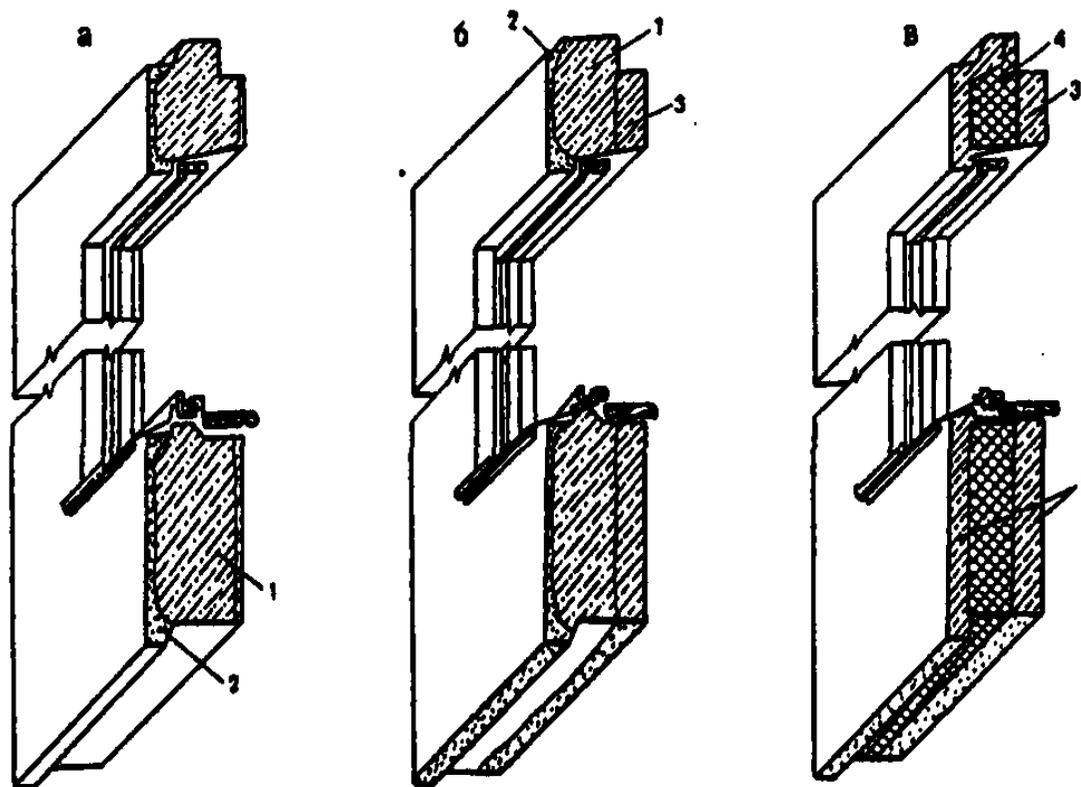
Бетонные панели наружных стен: а - однослойная; б - двухслойная; в - трехслойная; 1 - конструктивно - теплоизоляционный бетон; 2 - защитно-отделочный слой; 3 - конструктивный бетон; 4 - эффективный утеплитель
